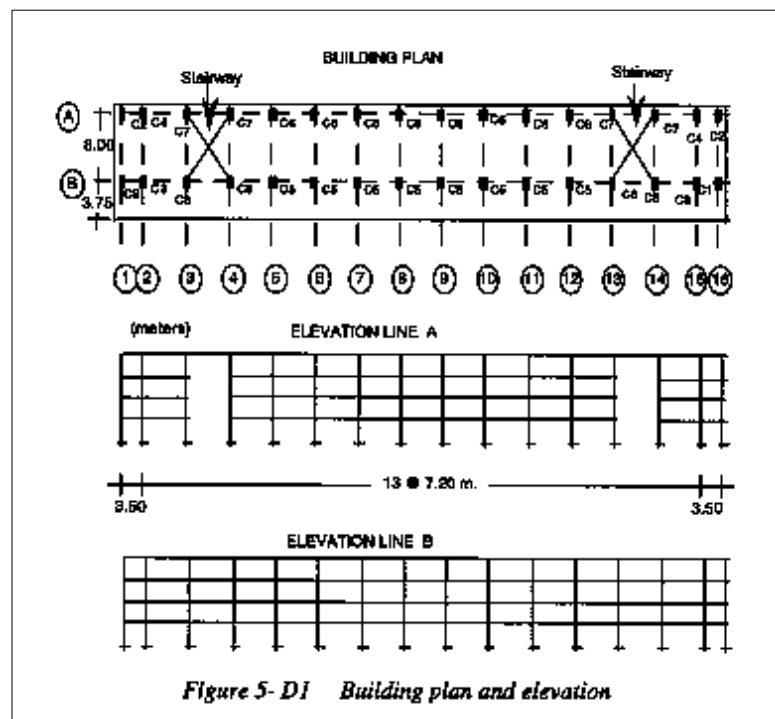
Configuración geométrica en planta y alzado del edificio en estudio. (Aguilar, F. Breña, Jara, Iglesias, & Picado, 1996)
